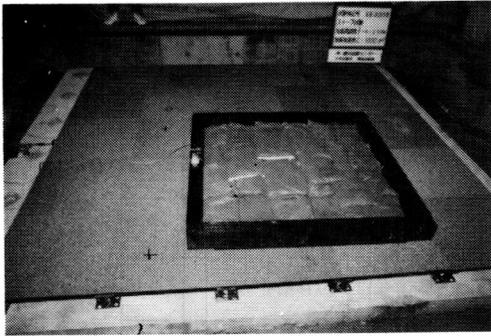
試験体記号；EE 300 Dの加振終了時の状況
